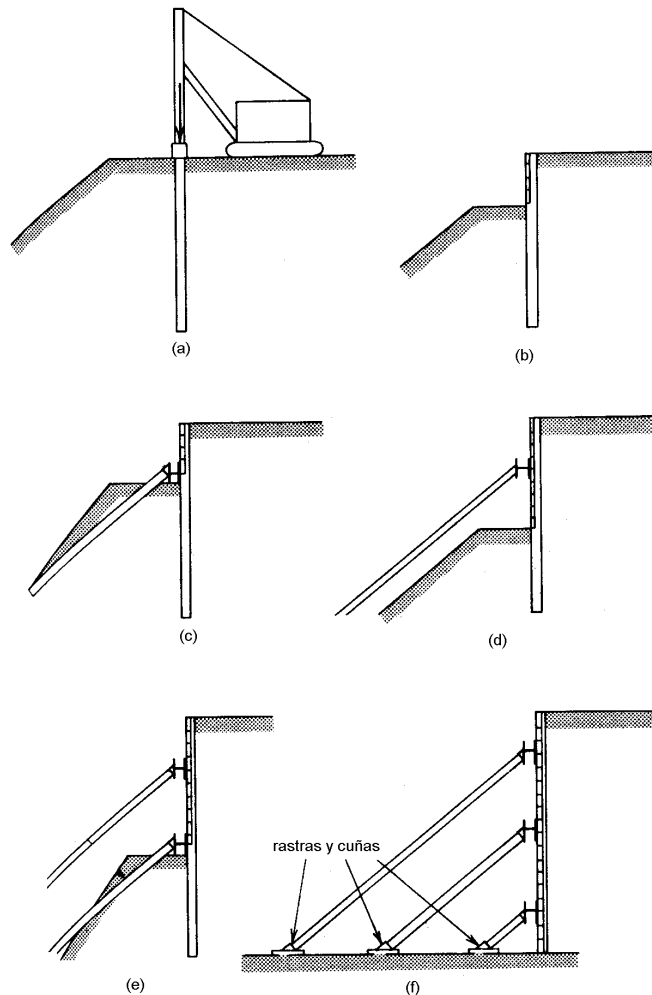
, Secuencia de construcción para muro Berlín: (a) Hincado de vigas metálicas; (b) primera etapa de excavación e instalación de madera; (c) colocación de vigas madrinas y puntales 1ª etapa (d) segunda etapa de excavación e instalación de madera; (e) colocación de vigas madrinas y puntales 2ª etapa; (f) repetición del proceso hasta el final de la excavación (Koerner , 1985)
